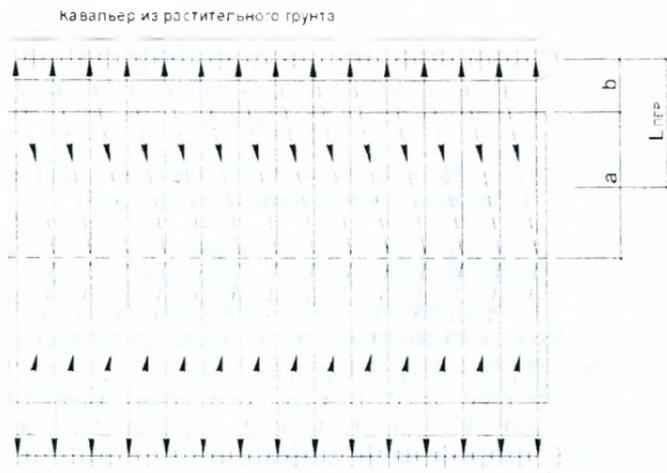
Схема срезки и перемещения растительного грунта
